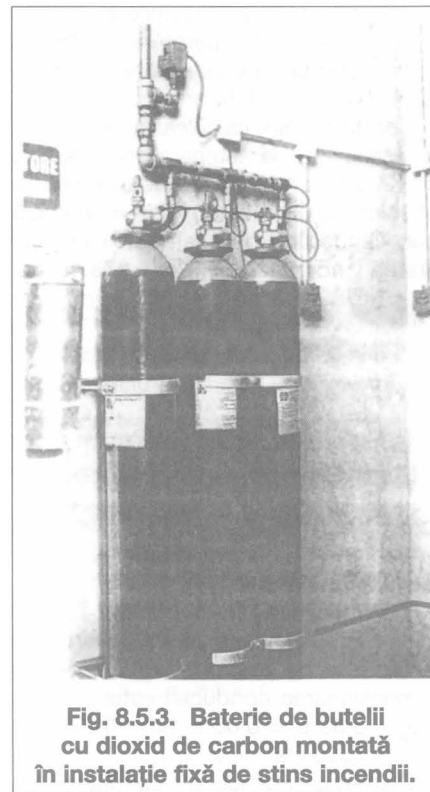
Baterie de butelii cu dioxid de carbon montată în instalație fixă de stins incendii.
